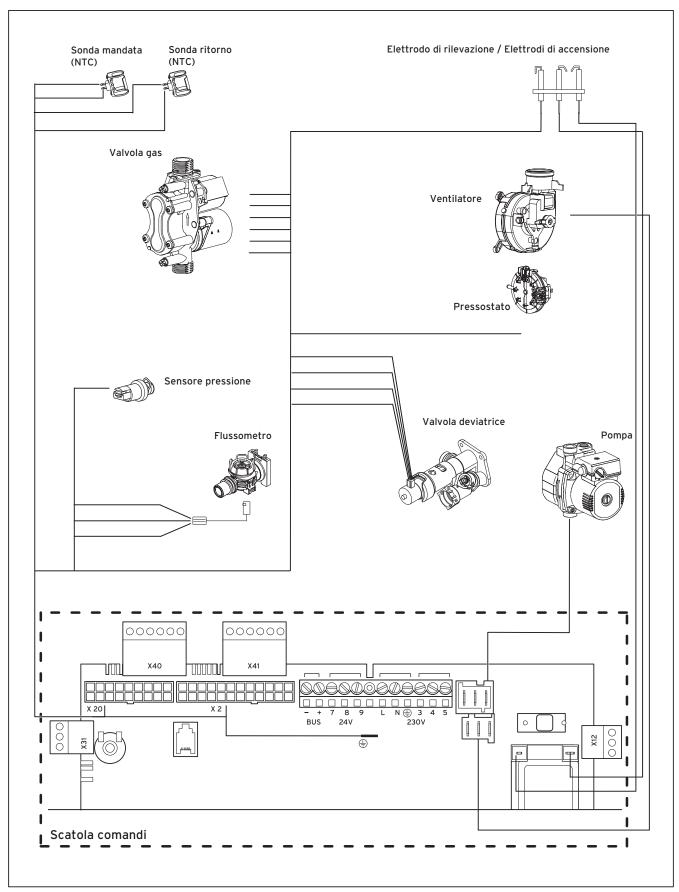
Schema di cablaggio turboBLOCK pro
